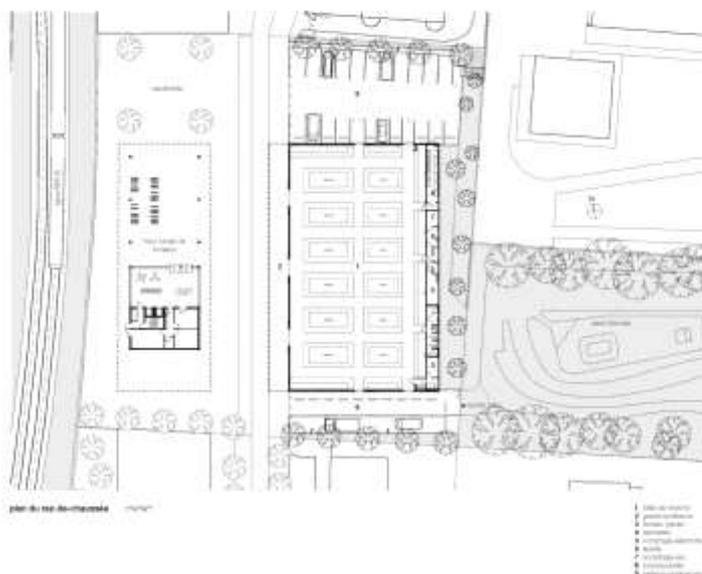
Planta baixa - Mercado de Cachan / Croixmariebourdon Architectures
